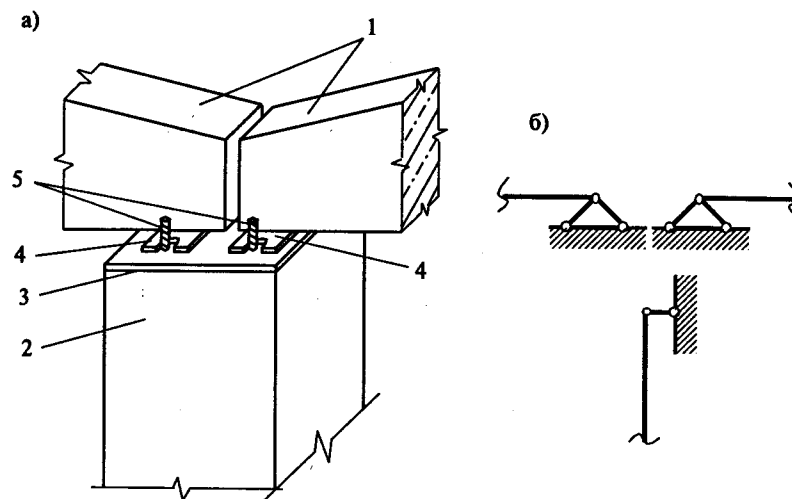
Шарнирное опирание стропильной железобетонной балки на колонну: а) схема опирания; б) расчетная схема опирания балок на колонну и колонны на балки; 1 — балки; 2 — колонна; 3 — опорная плита колонны; 4 — закладные детали балки; 5 — болты (гайки не показаны)
